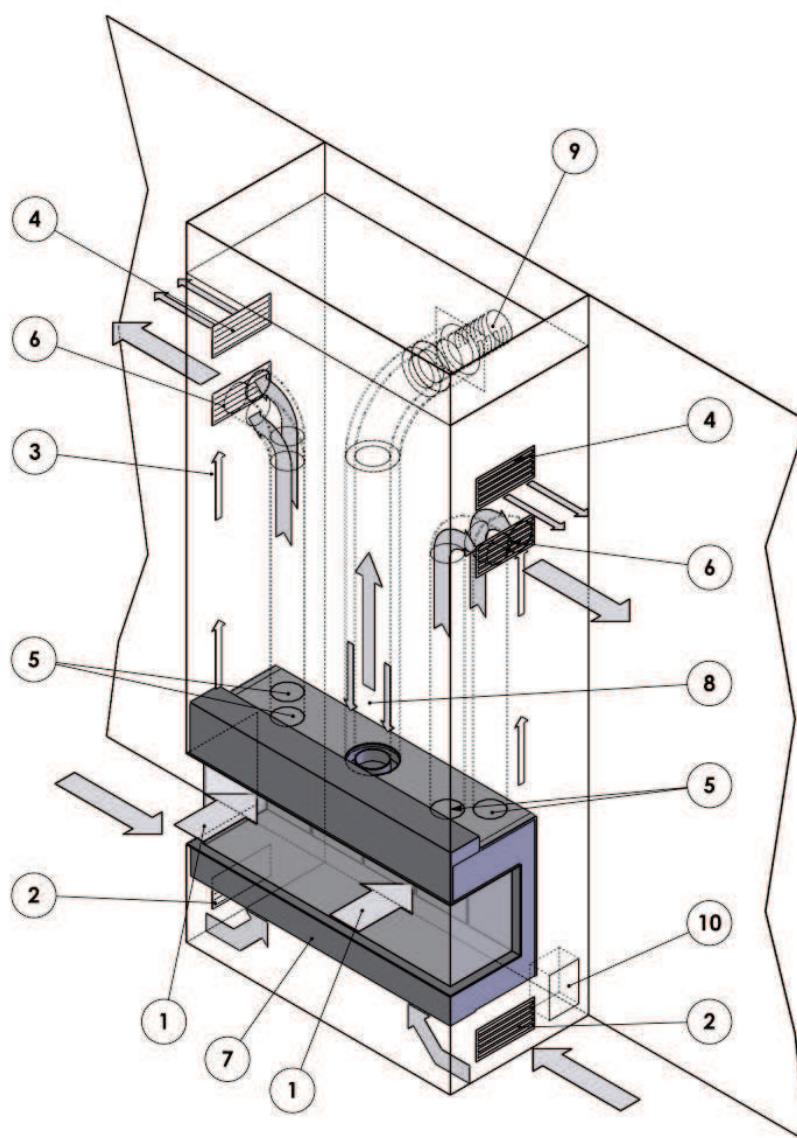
Aparato instalado dentro de una chimenea ventilada
